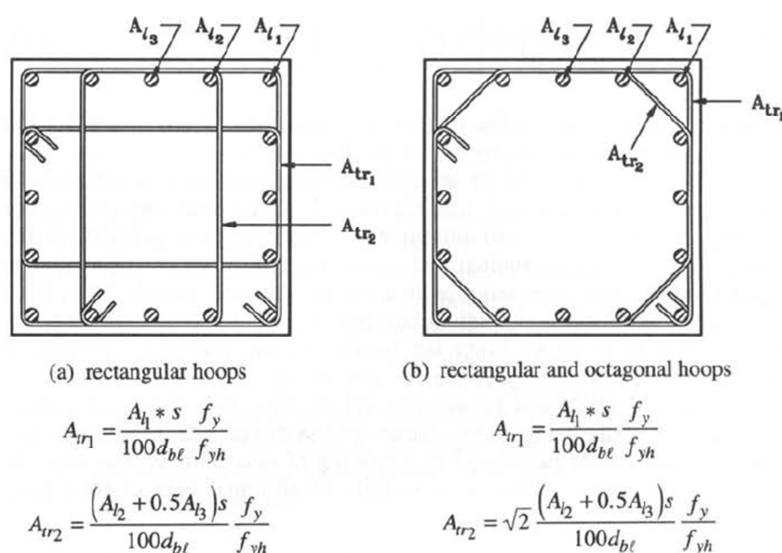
Restricción para pandeo del refuerzo longitudinal en columnas rectangulares (Tomado de Priestley, Seible y Calvi, 1996)
